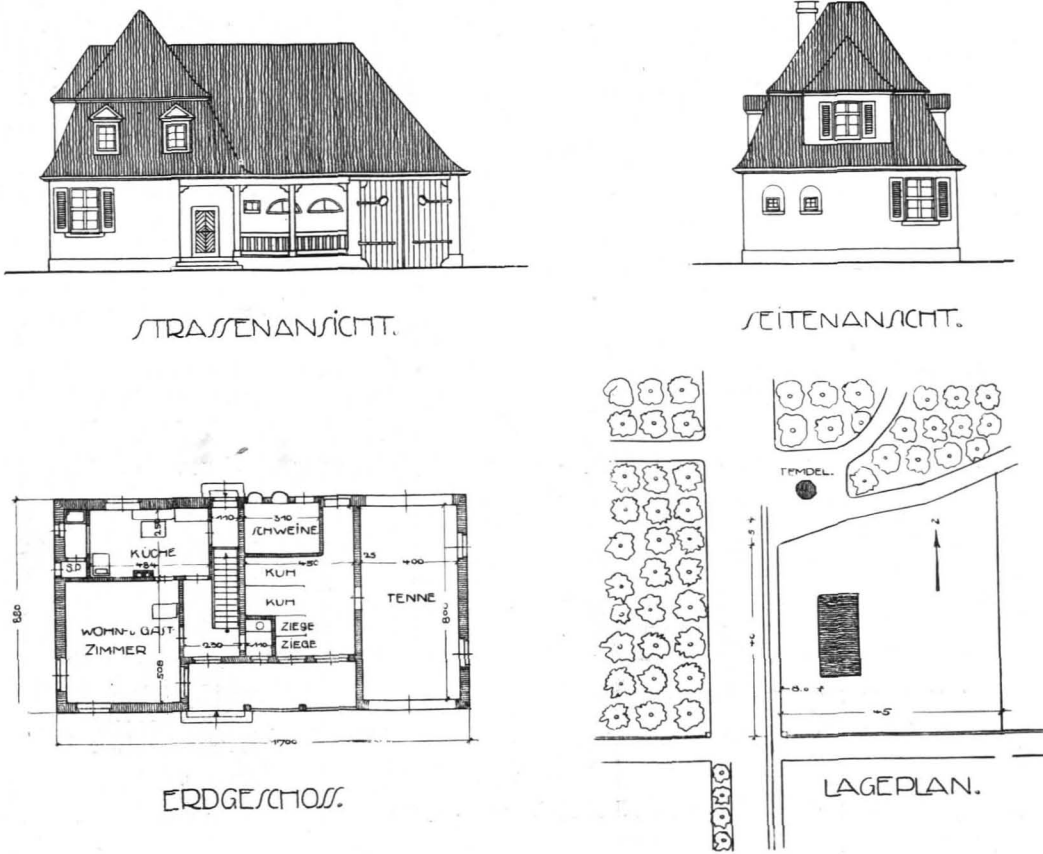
ANSICHTEN, GRUNDRISS UND LAGEPLAN. (M. 1 : 315).
